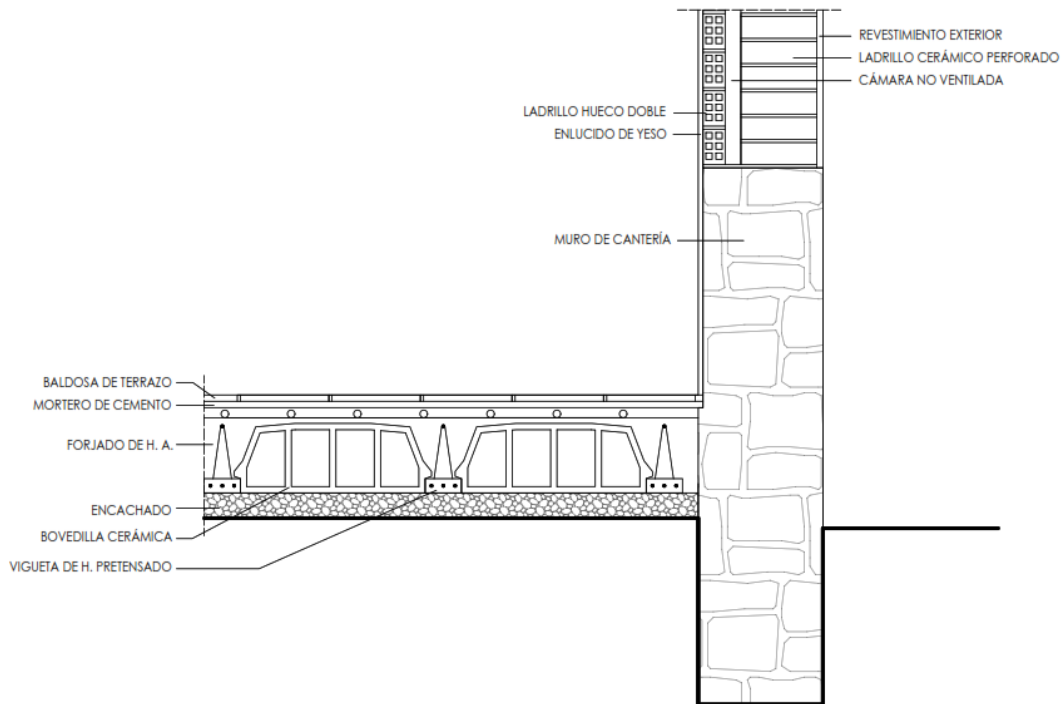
Detalle constructivo de muro en contacto con el terreno, forjado y cerramiento.
